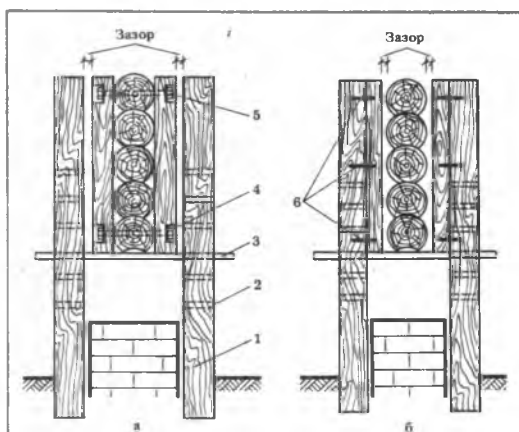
Вывешивание стен: а — со скользящими сжимами; б — скользящих между сжимами; 1 — стойка; 2 — отверстия; 3 — штырь; 4 — шайба; 5 — болт; 6 — скобы
